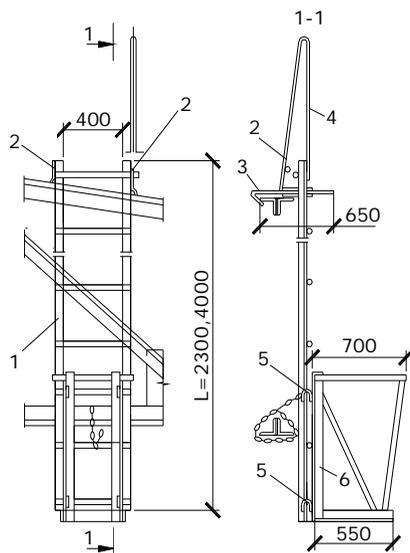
Лестница с люлькой для навески на металлическую ферму:
